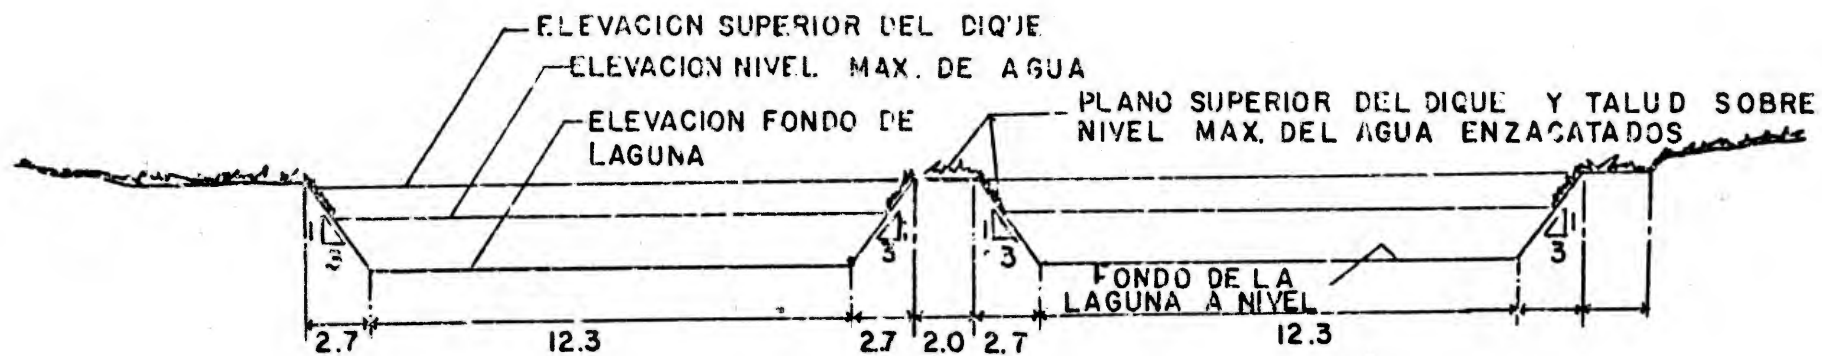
CORTE LONGITUDINAL DEL SISTEMA DE LAGUNAS escala horizontal 1:500 vertical 1:200
